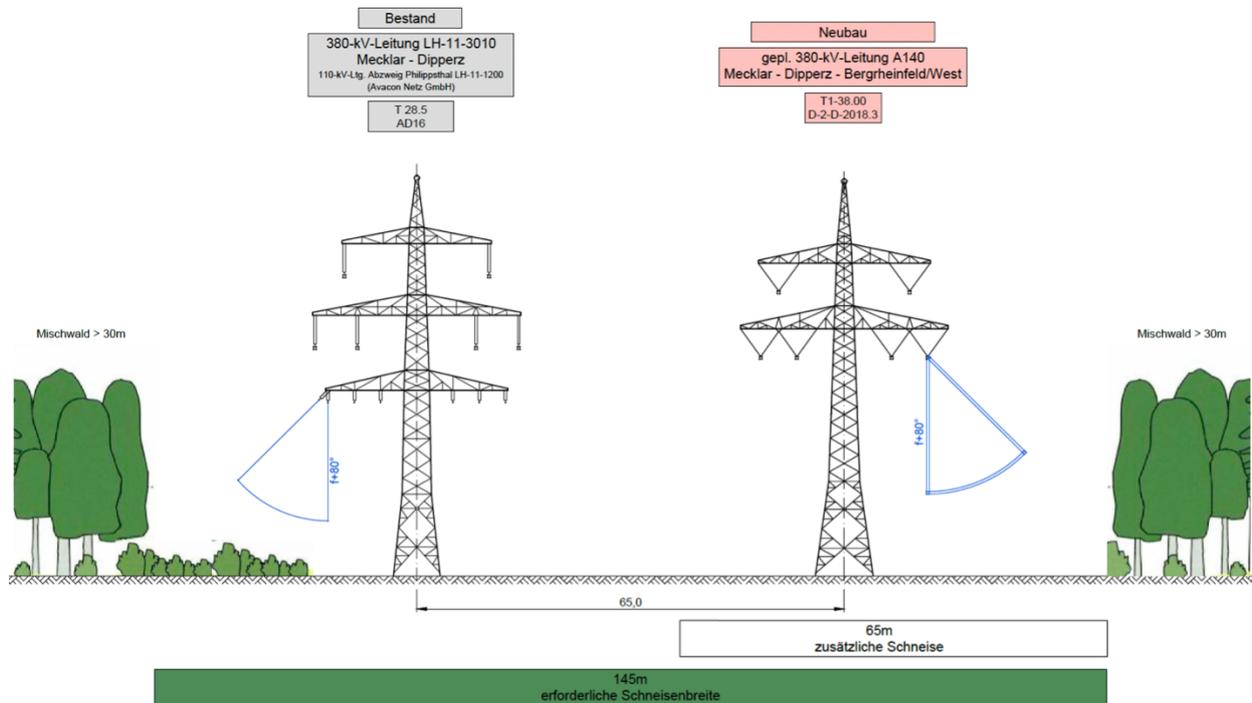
Waldschneise bei Parallelführung mit Gemeinschaftsleitung (alle Maße in m)
